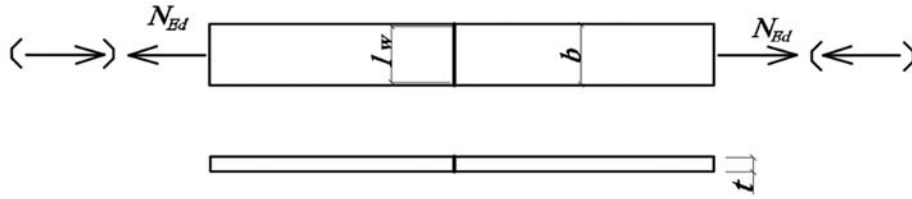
Прямой стыковой сварной шов
